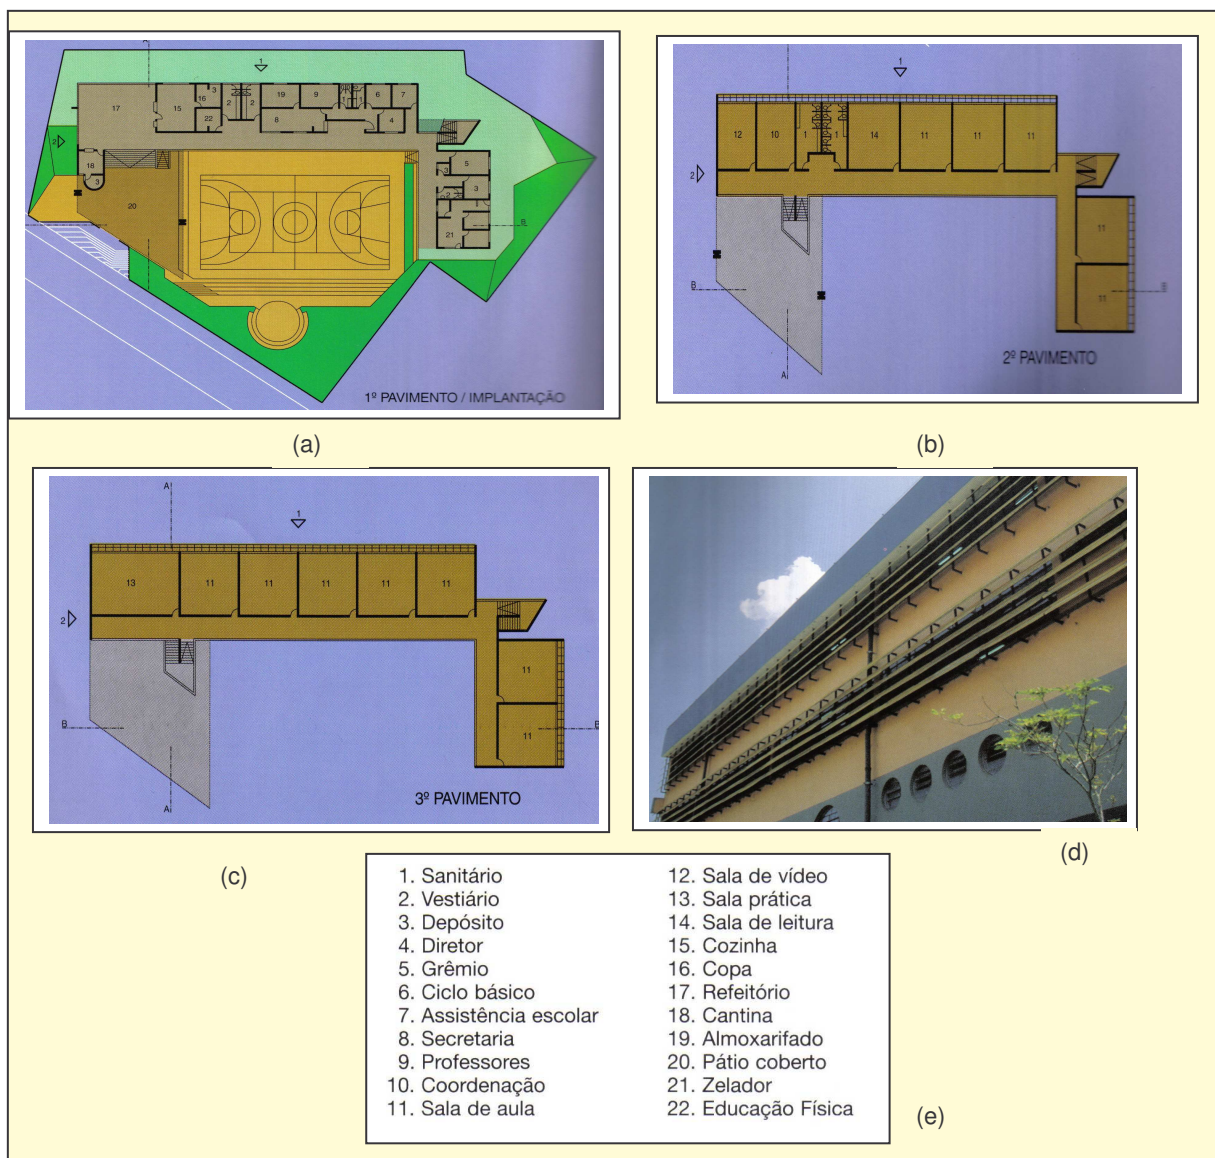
EE Professor Jesus José Attab (1995-1998), em Parelheiros, São Paulo. Em (a): planta baixa do 1.º pavimento e implantação; (b): planta baixa do 2.º pavimento; (c): planta baixa do 3.º pavimento; (d) fachada; (e) legenda.
